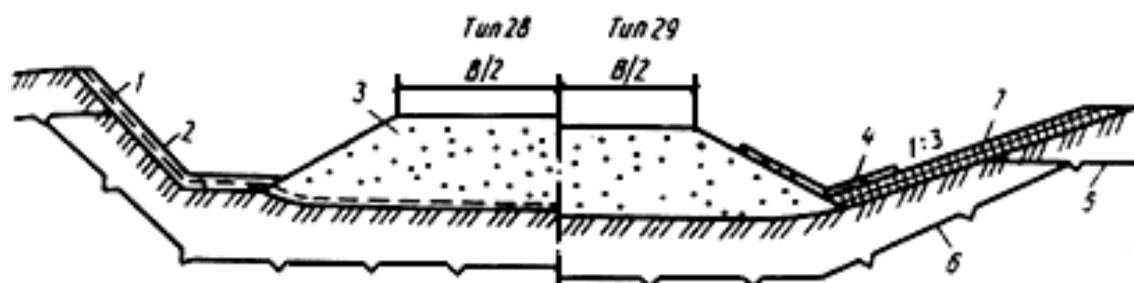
Поперечные профили выемки на местности со сложными гидрогеологическими условиями: 1 – геотекстиль; 2 – торфопесчаная смесь; 3 – грунт замены (насыпь); 4 – бетонные плиты; 5 – ВГВМ в естественных условиях; 6 – то же после постройки выемки; 7 – теплоизолирующий слой из торфа (по расчету)
